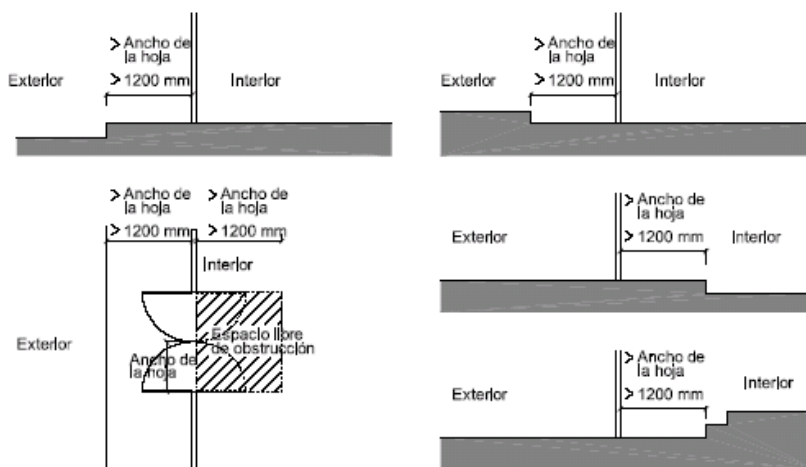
Distancia entre la puerta de acceso y el escalón más próximo
